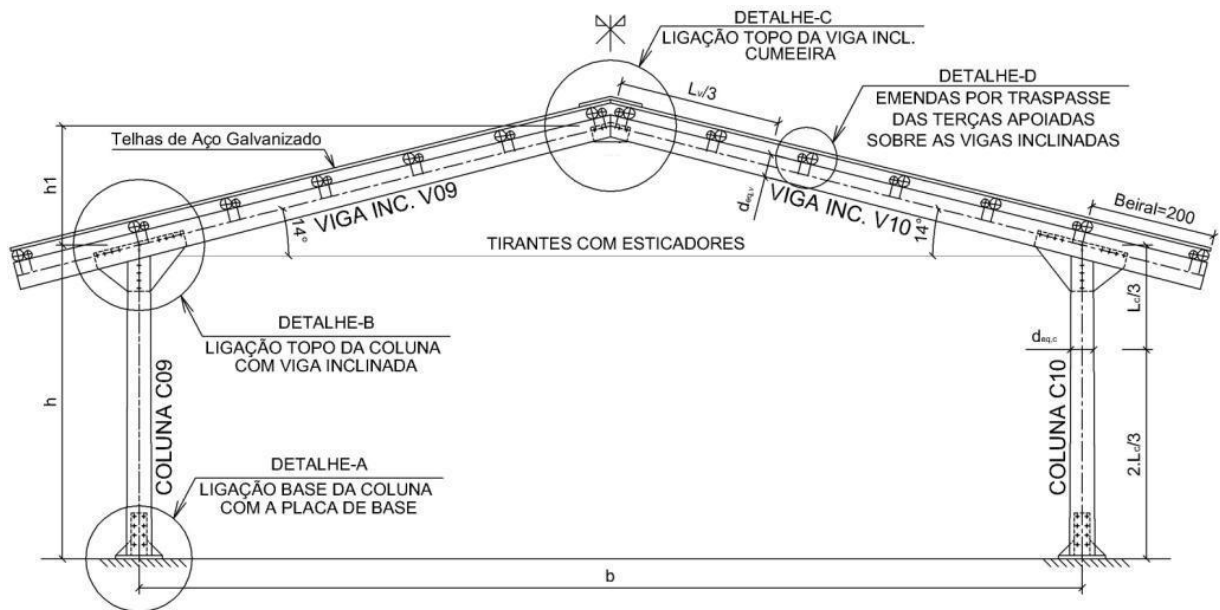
Corte A-A: vista de elevação do pórtico central (sem escala).
